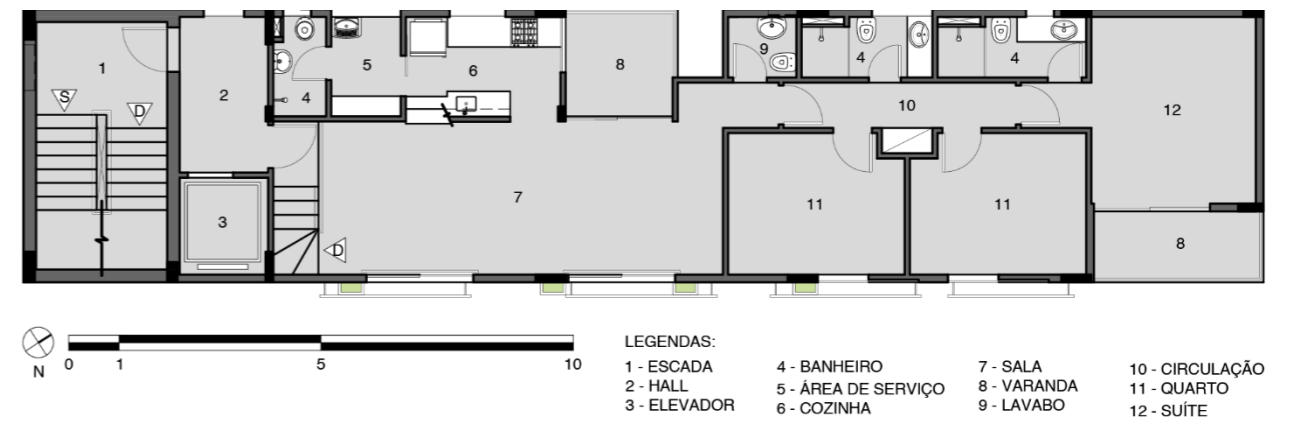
Planta do sétimo pavimento do Montevidéu 285
